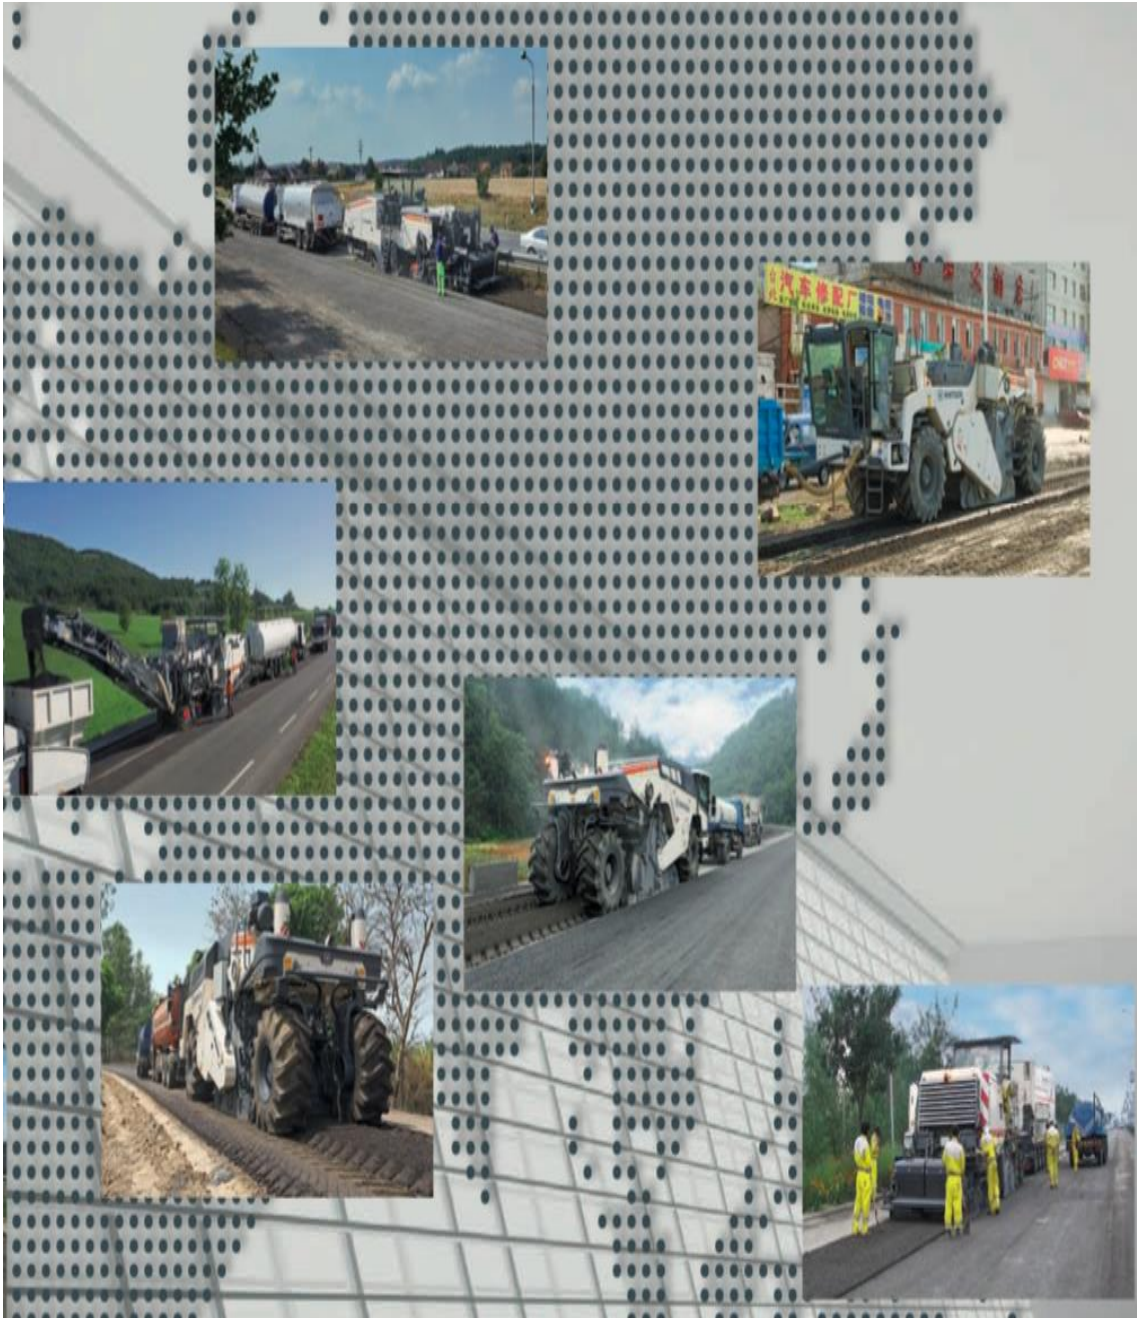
Carretera pavimentada haciendo uso del asfalto espumado
